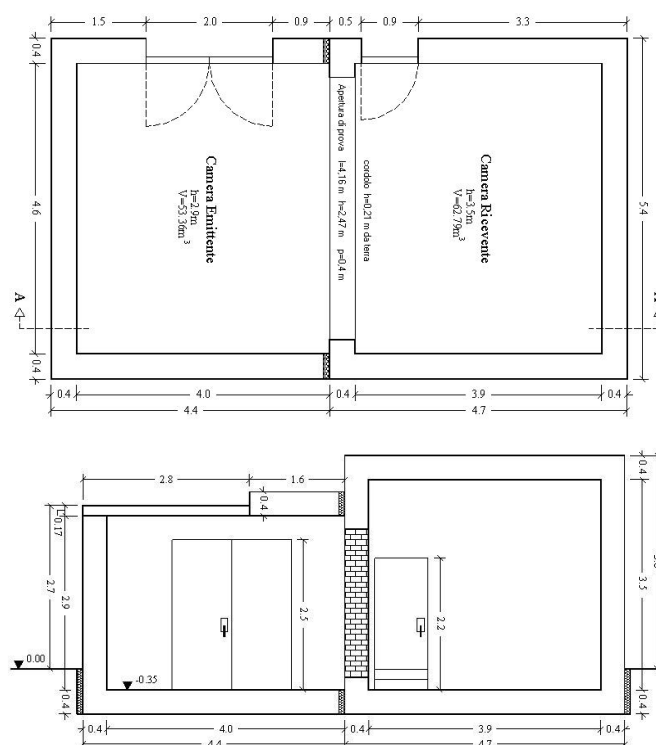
Pianta (sopra) e sezione longitudinale (sotto) delle camere riverberanti accoppiate utilizzate per l'esecuzione delle misure.
